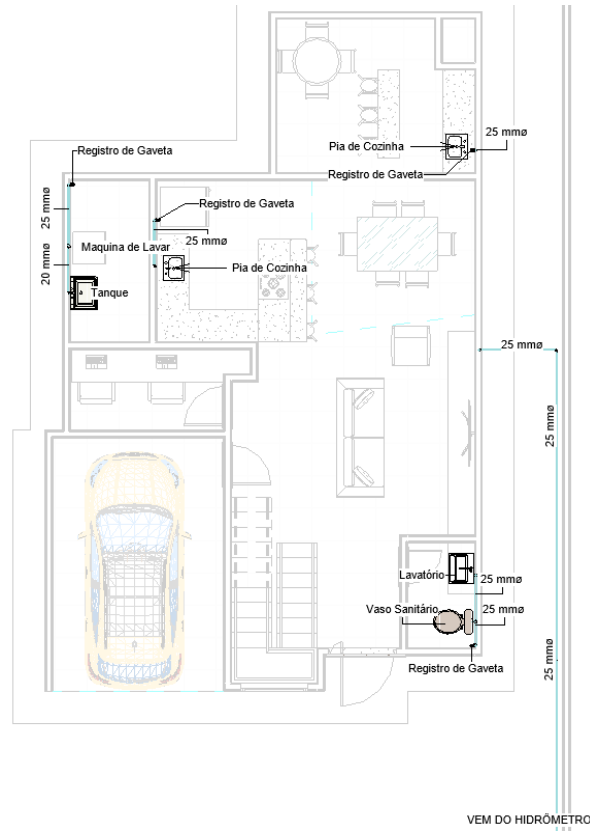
Planta Baixa da Instalações de Água Fria – Pavimento Inferior
